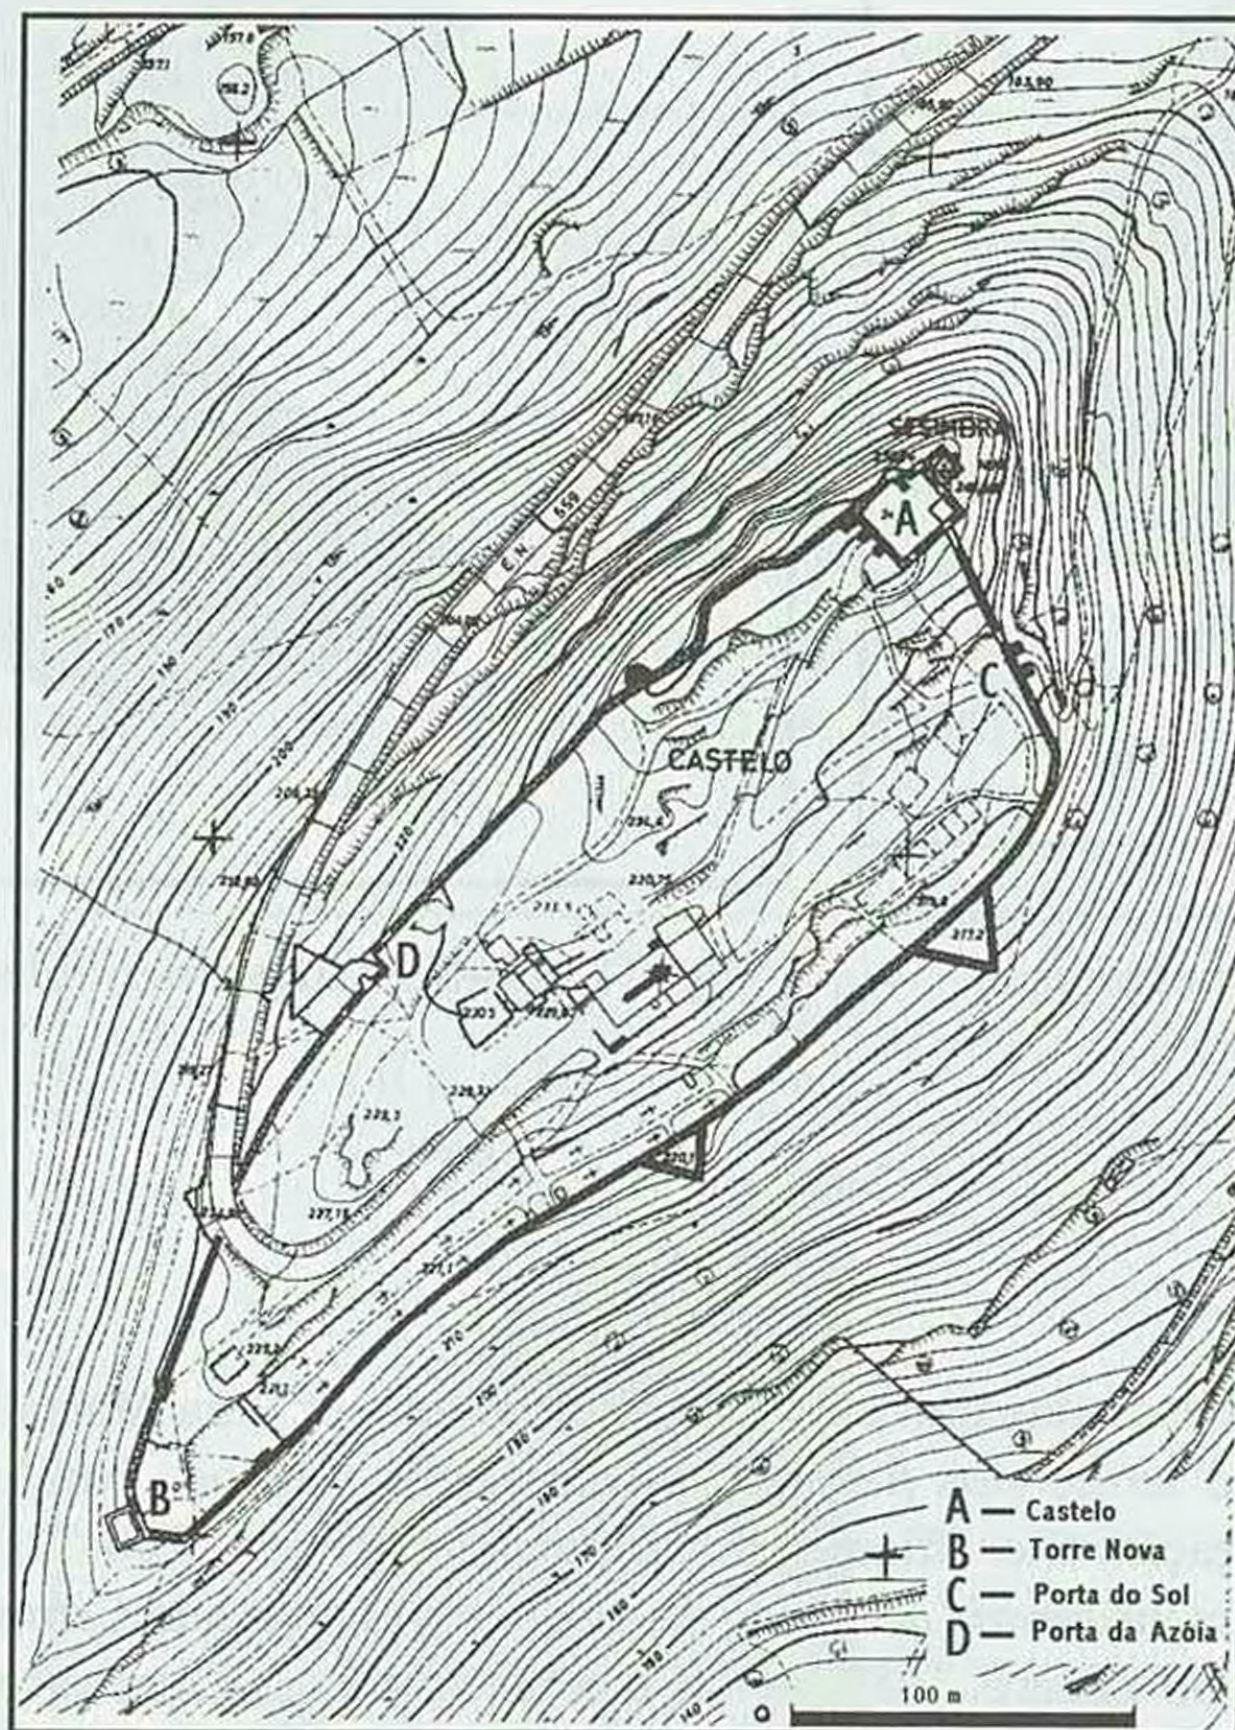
«Castelo de Sesimbra: planta das estruturas hoje existentes»⁶⁵
